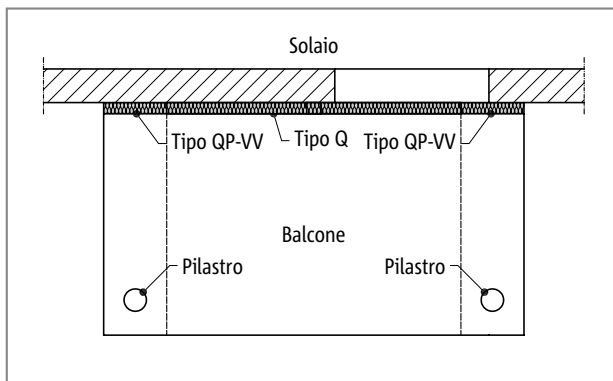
Schöck Isokorb® tipo QP e tipo Q-VV, balcone con appoggio su pilastri; raccordo con diversi gradi di rigidità dell'appoggio
